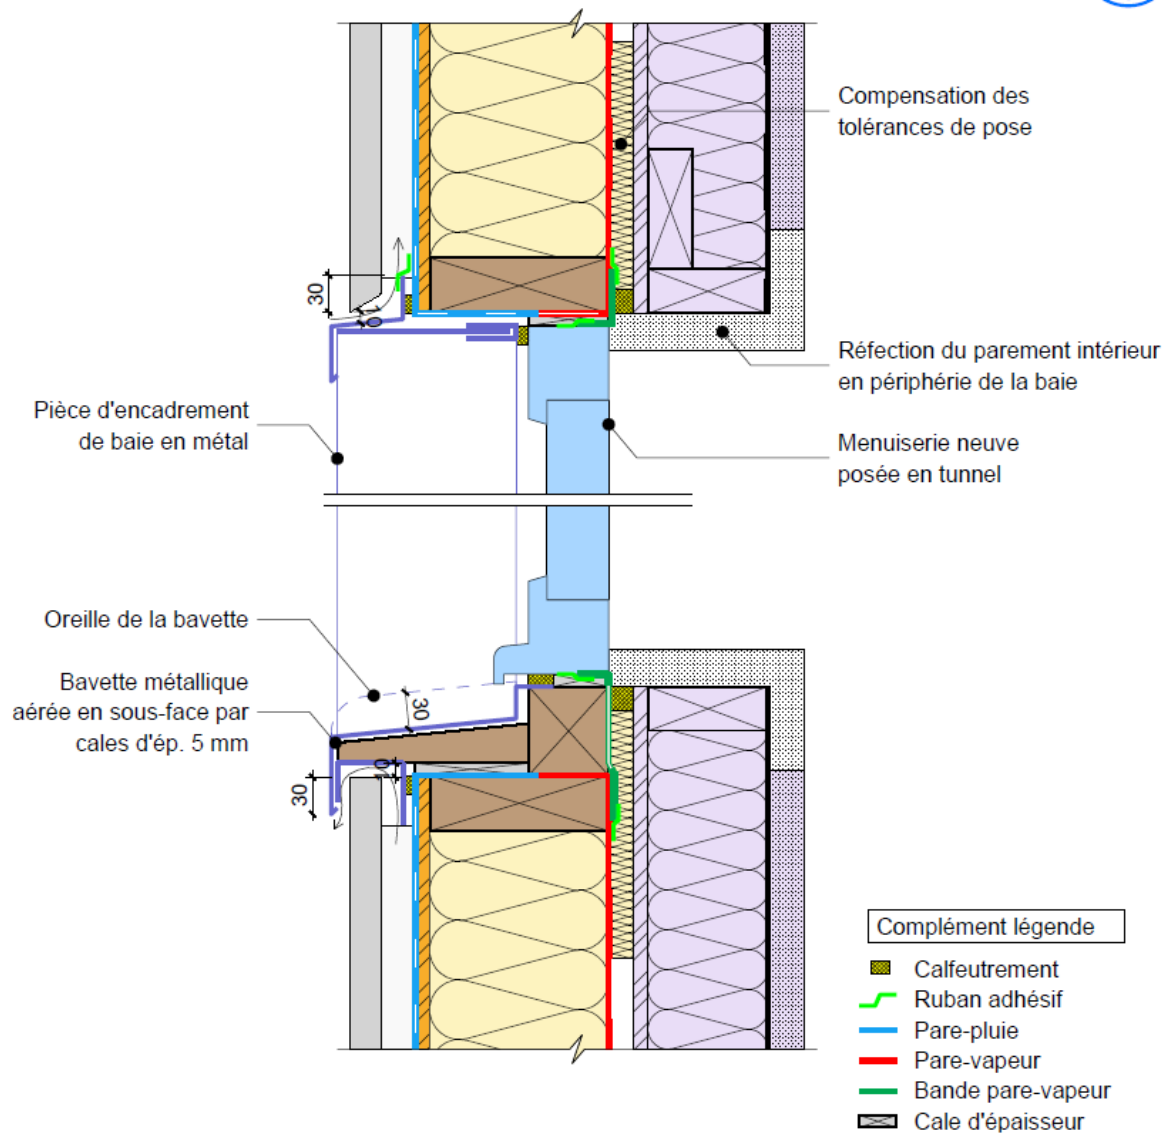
Baie avec encadrement rapporté en métal (coupe verticale)
